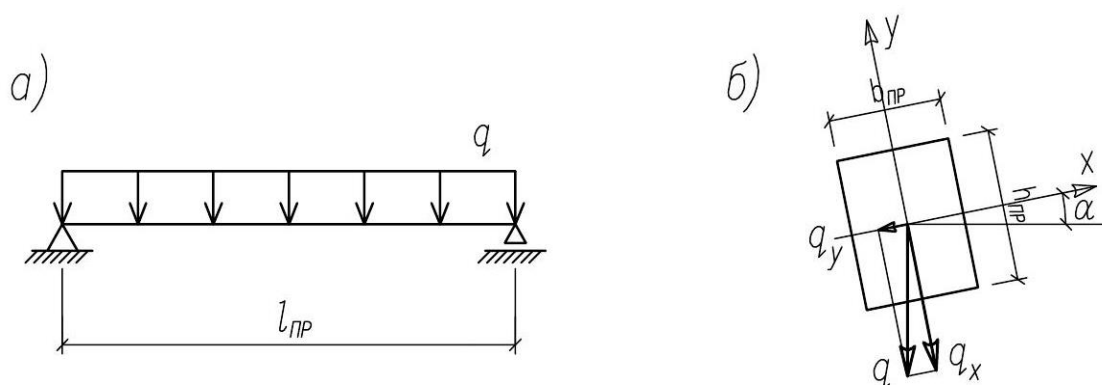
Расчетная схема (а) и поперечное сечение (б) прогона
